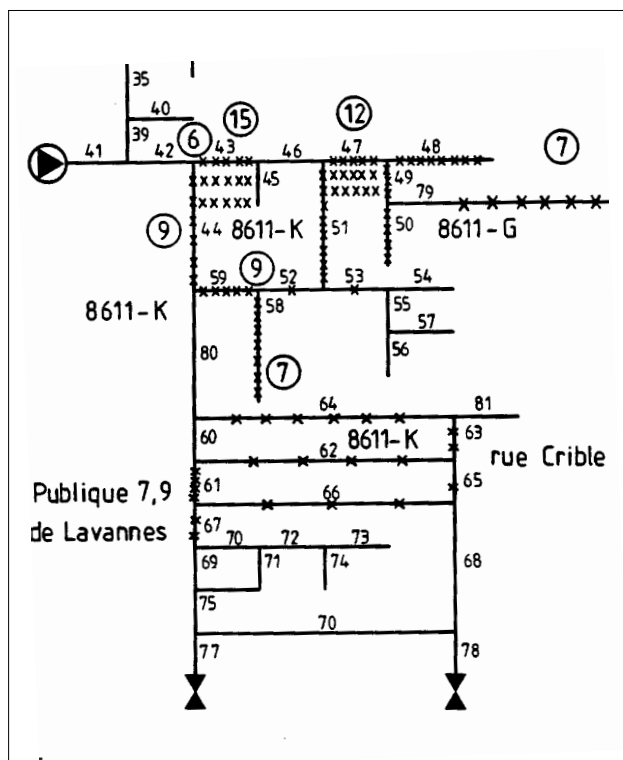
Plan schématique papier d'un réseau: la tenue à jour nécessite deux interventions, l'une sur le plan topographique, l'autre sur le plan schématique.
